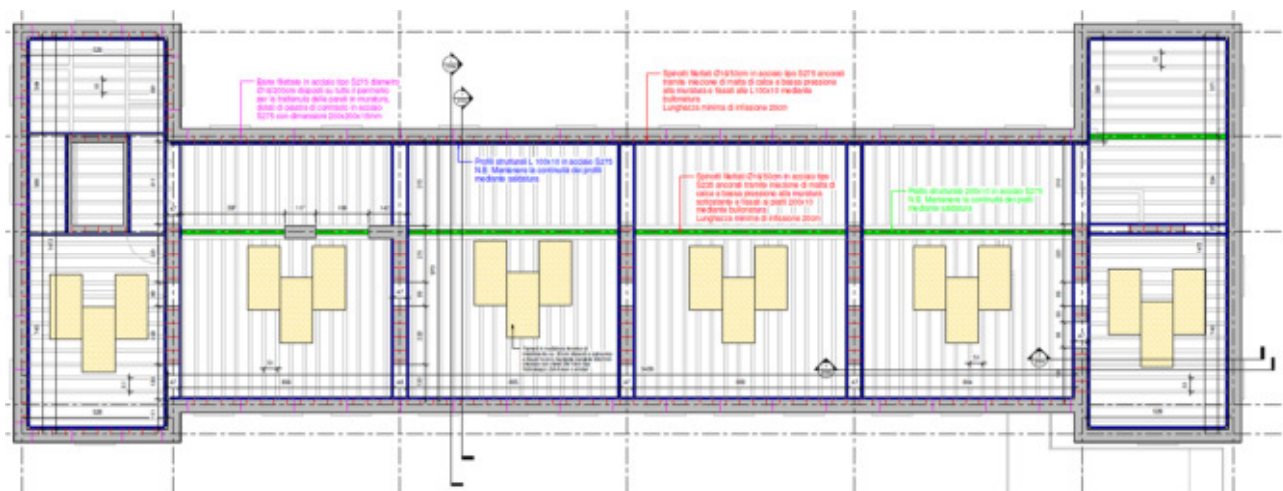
Pianta del sottotetto con indicazione dell'intervento
